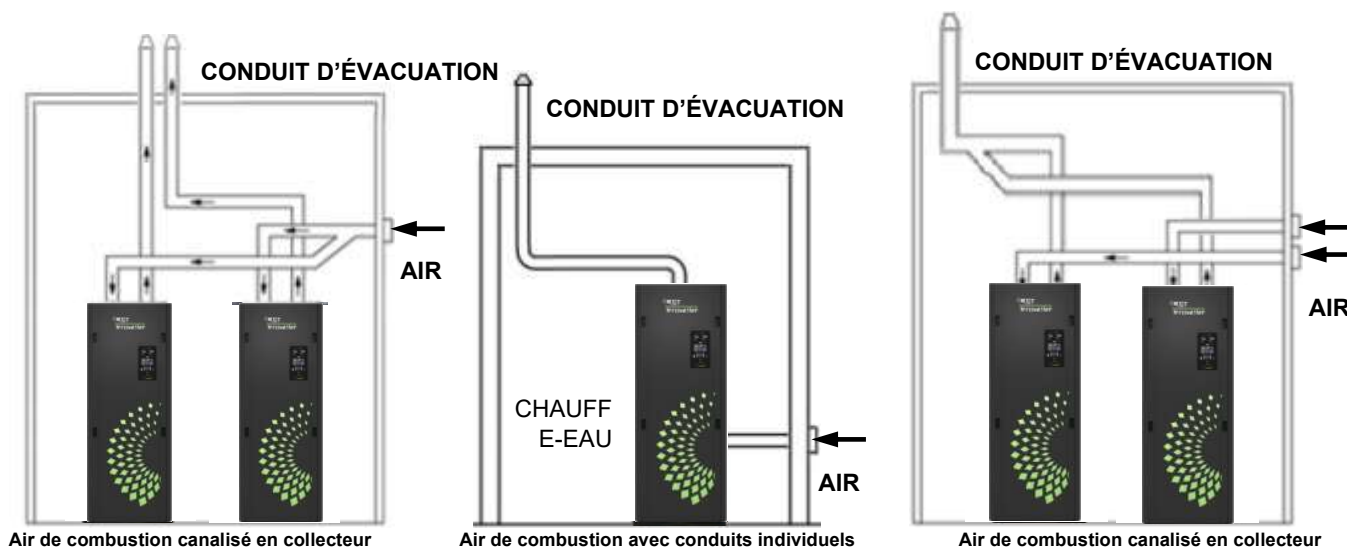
Conduits d'évacuation individuels : installations ACCEPTABLES
